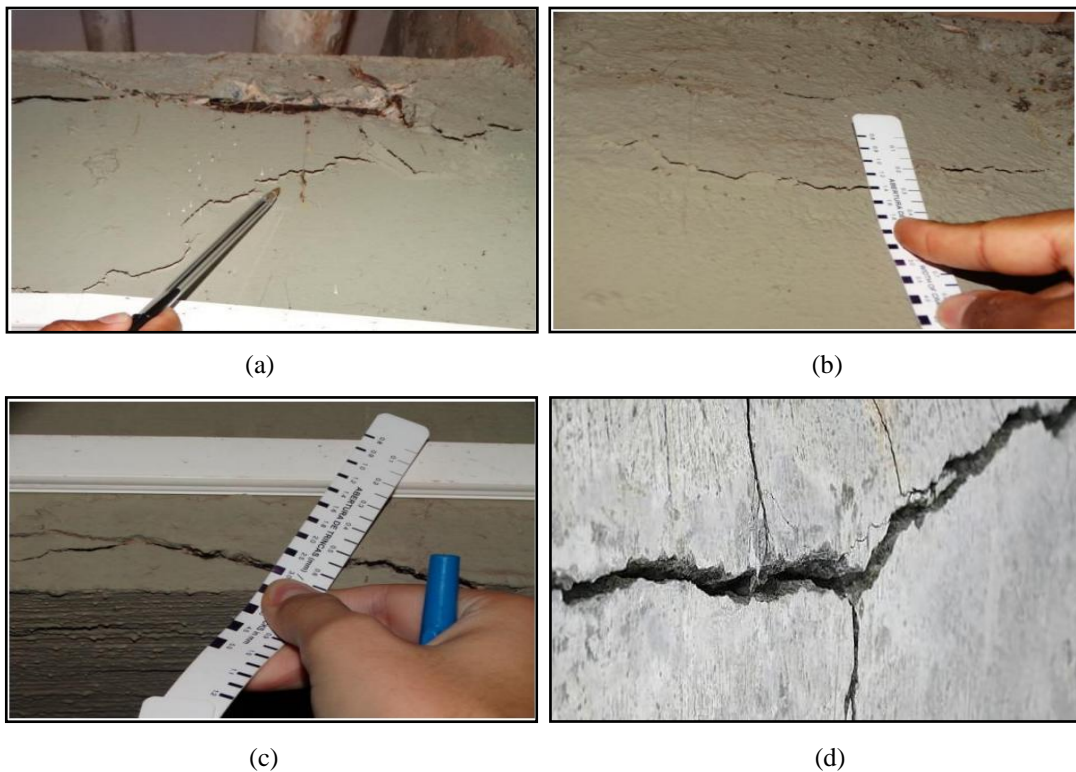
(a) fissura; (b) trinca; (c) rachadura e (d) fenda
